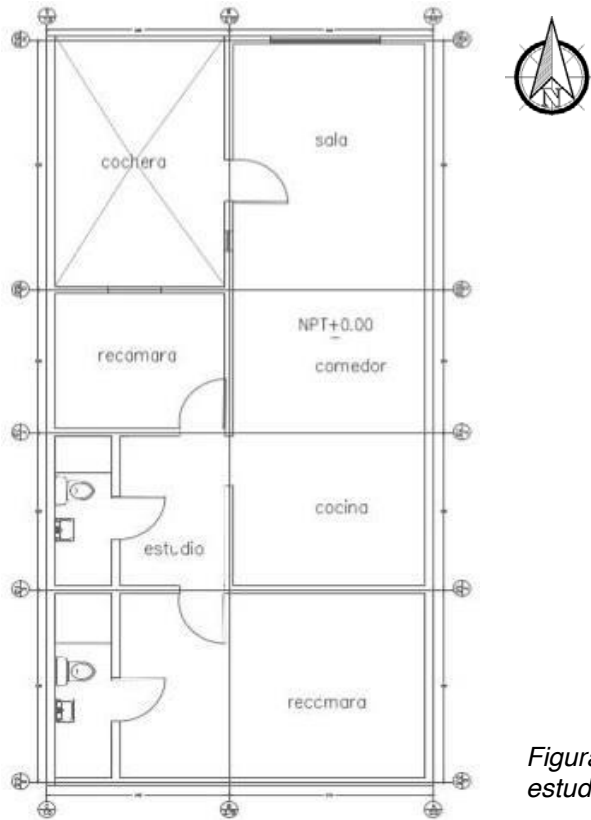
Planta arquitectónica, vivienda de estudio, Mexicali, B.C.
